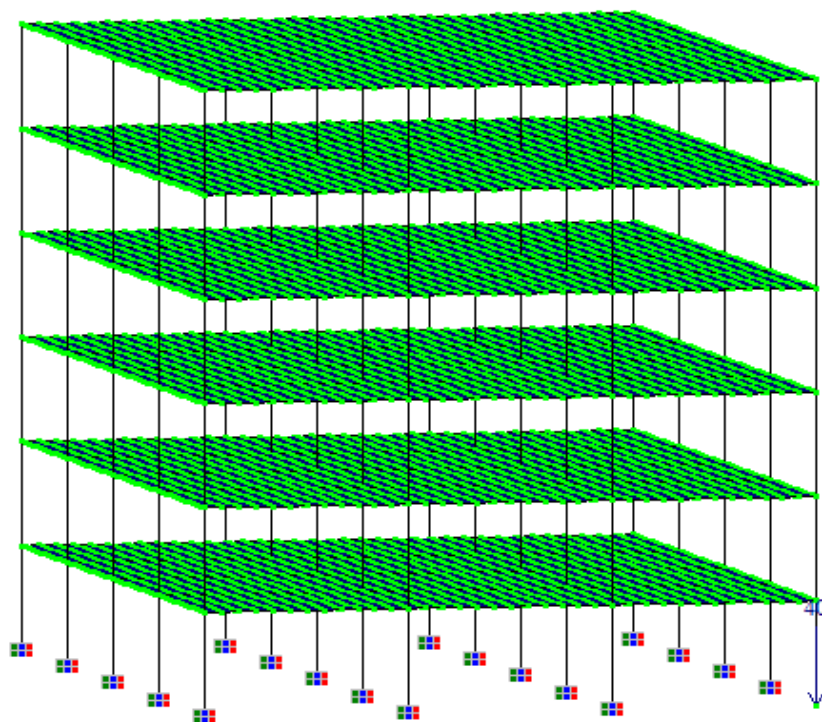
Schéma illustratif du modèle d'étude du bâtiment avec planchers en hourdis à 6 niveaux avec un chargement vertical sur le poteau d'angle
